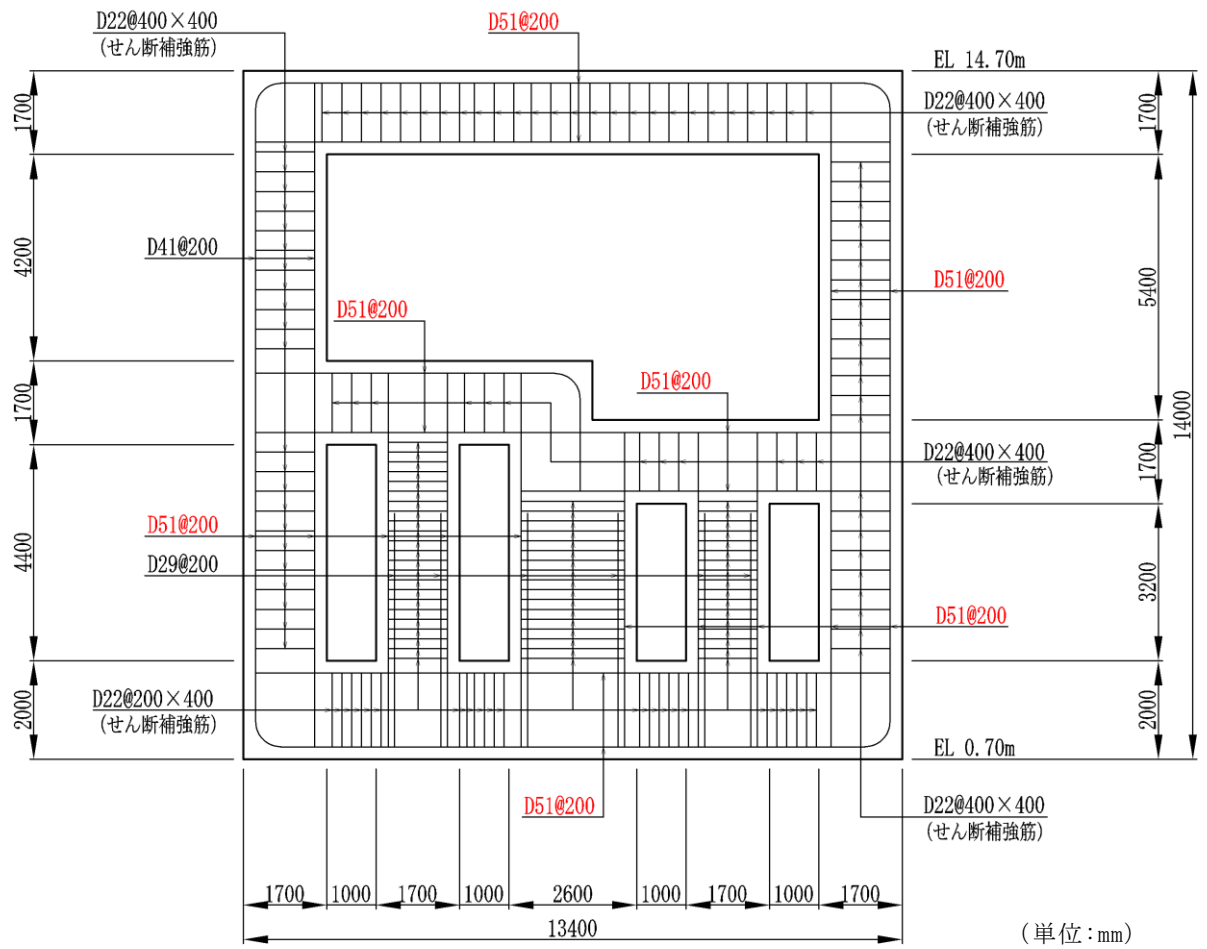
第 1 ベントフィルタ格納槽概略配筋図 (B-B 断面)
